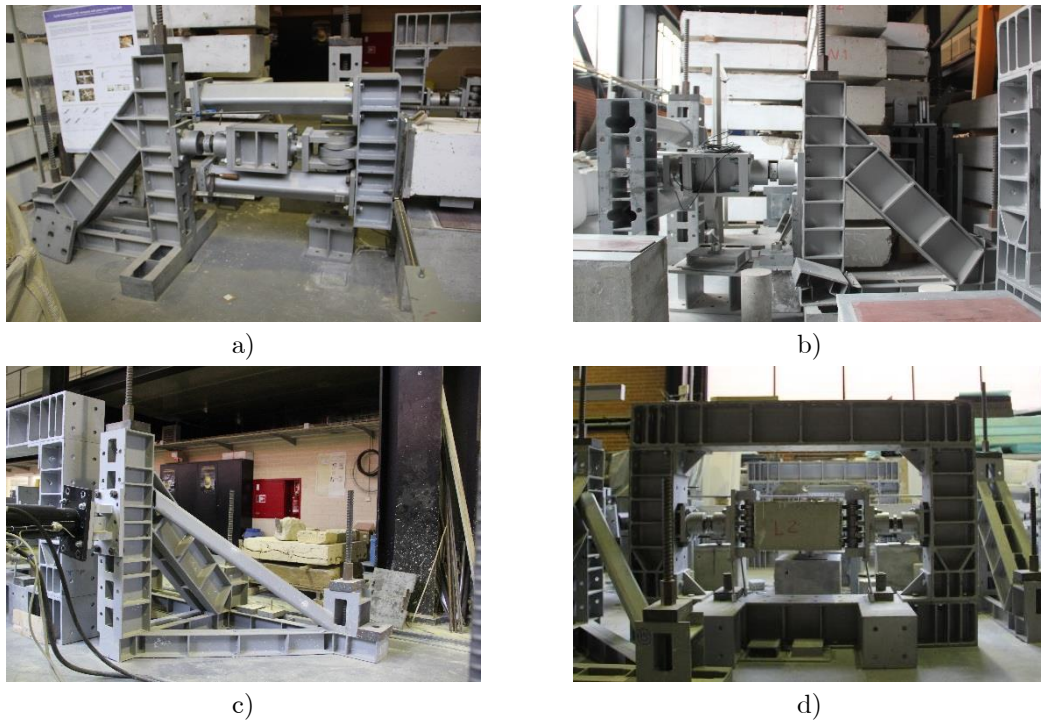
Elementos metálicos de reação: a) e b) Apoio duplo na base do pilar inferior; c) Estrutura metálica de reação ao servo-atuador; d) Pórtico metálico de reação para a viga.
